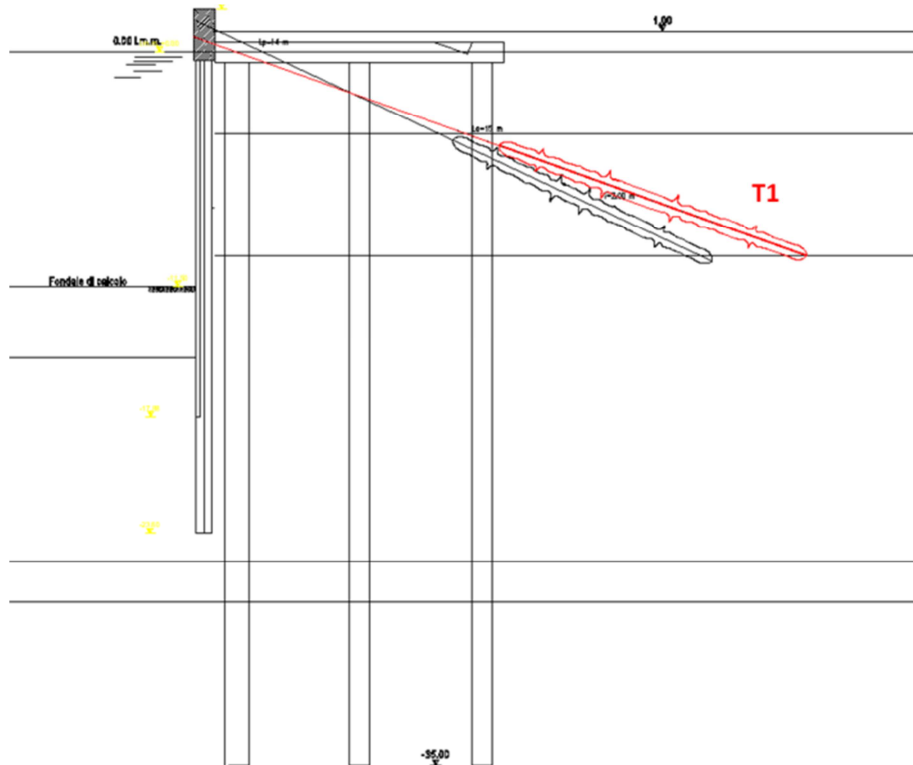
Sezione tipo intervento di adeguamento con indicazione dei tiranti di ancoraggio
